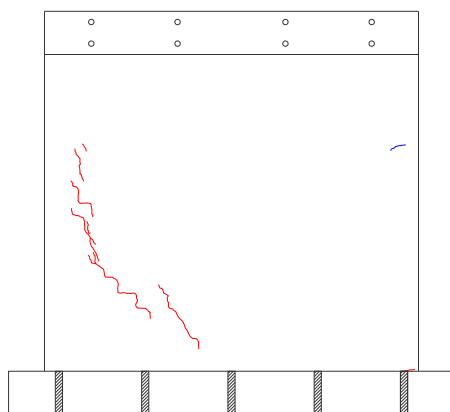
Agrietamiento de muro de albañilería confinada con ladrillos sólido artesanal en la distorsión 1/2150.
